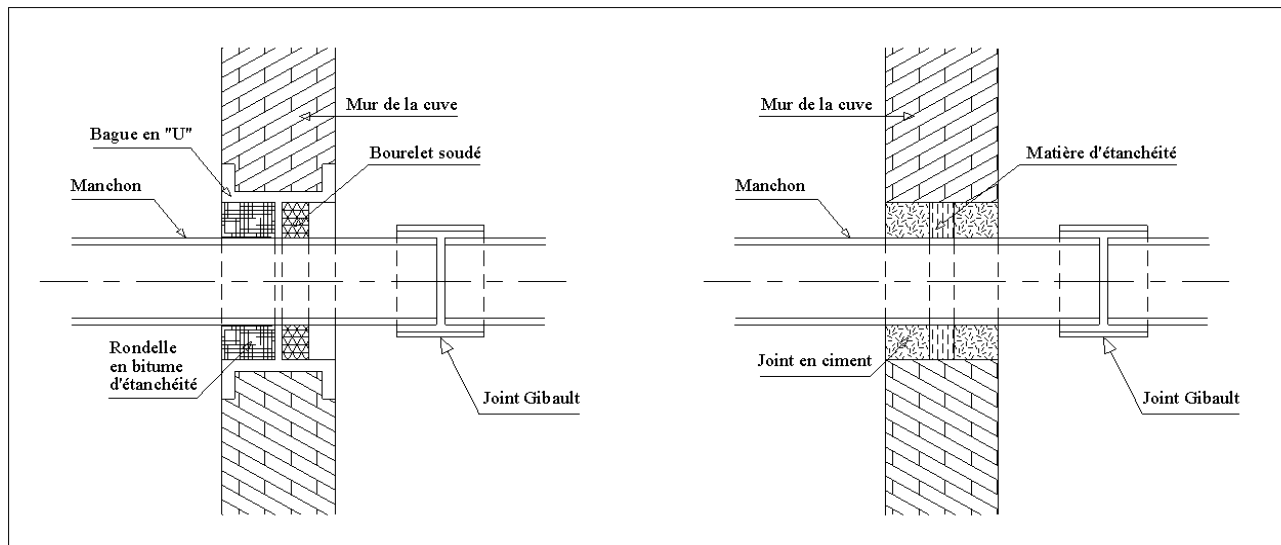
Traversée des conduites (manchon à bout lisse)
